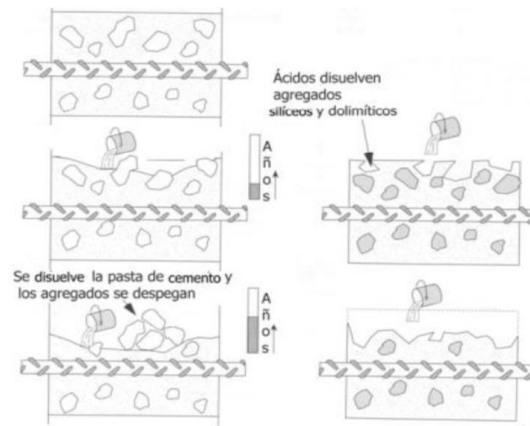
Esquema de deterioro del concreto causado por los ácidos
